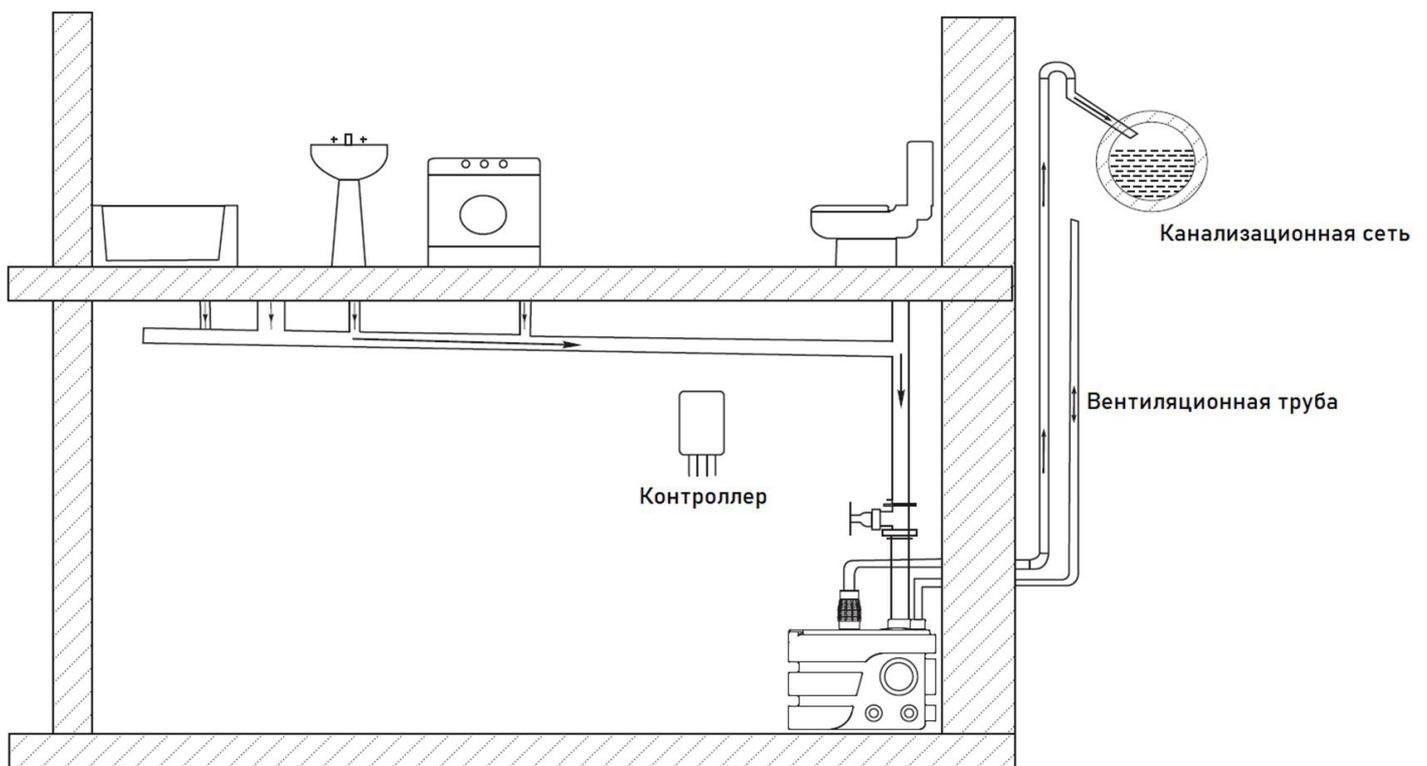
Установка насосной станции на полу цокольного этажа (подвала)
